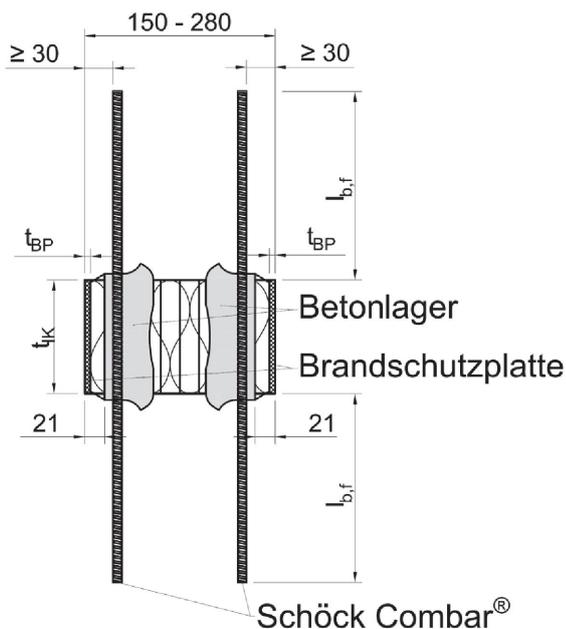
Schöck Isokorb® CXT Typ A für Attiken und Brüstungen
